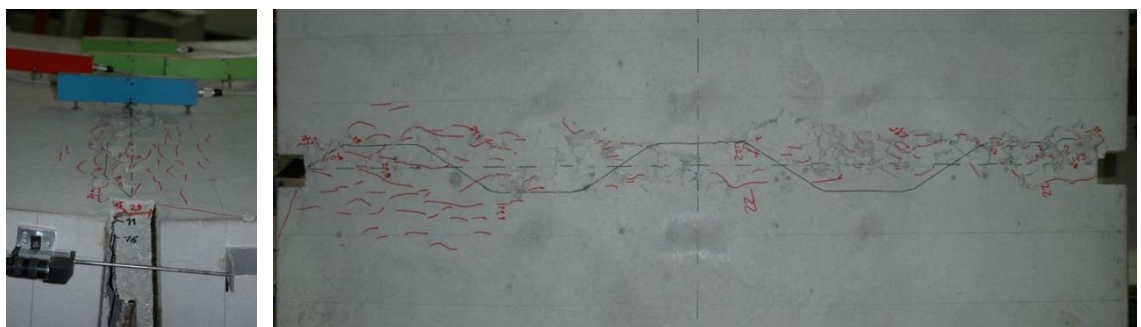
Versagen der Betondruckzone oben bei Körper R-Q2; Ansicht und Grundriss im Bereich des Trapezblechs
